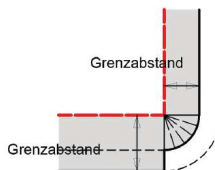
Vorspringende Gebäudeteile (Grundriss und Schnitt)
